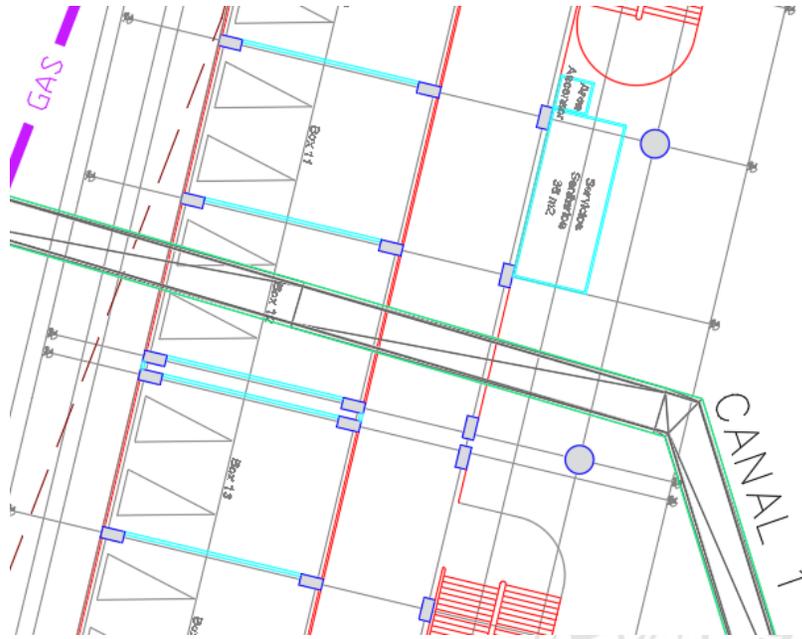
Vista en planta cruce de Canal 1 con zona de Boxes.
